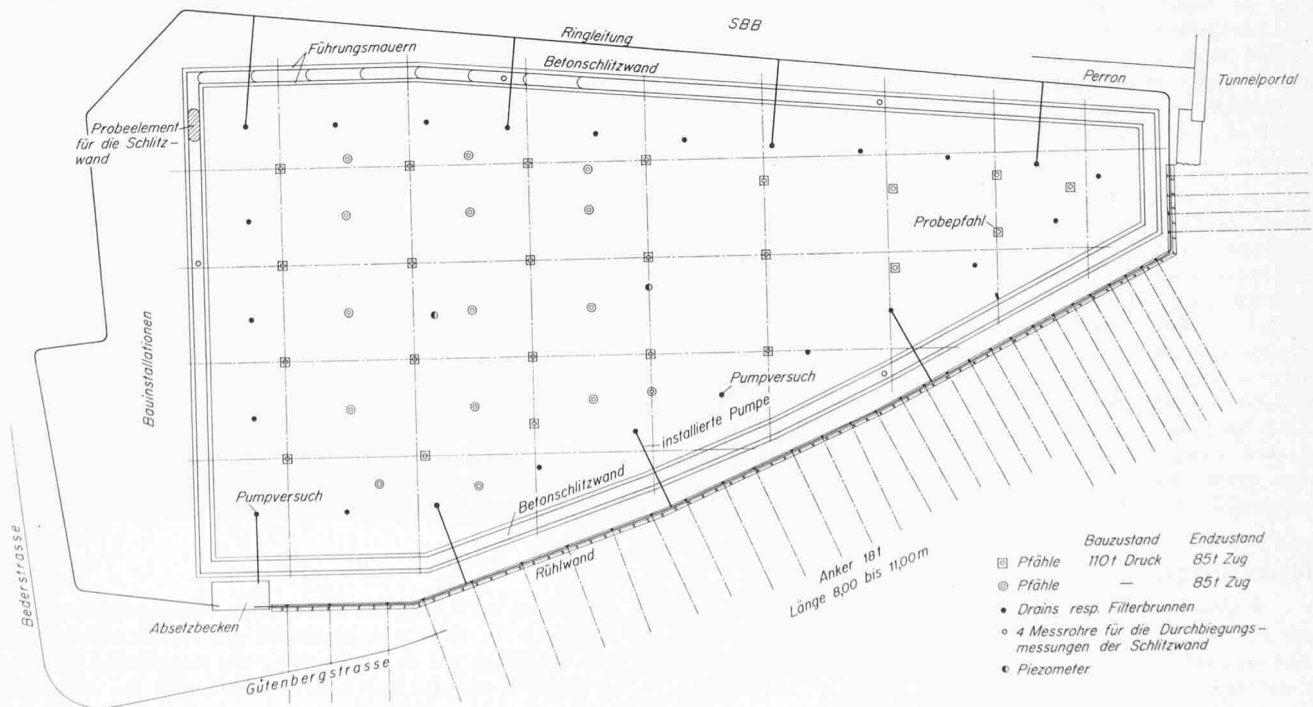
Grundriss des Baureals, Massstab 1:500
